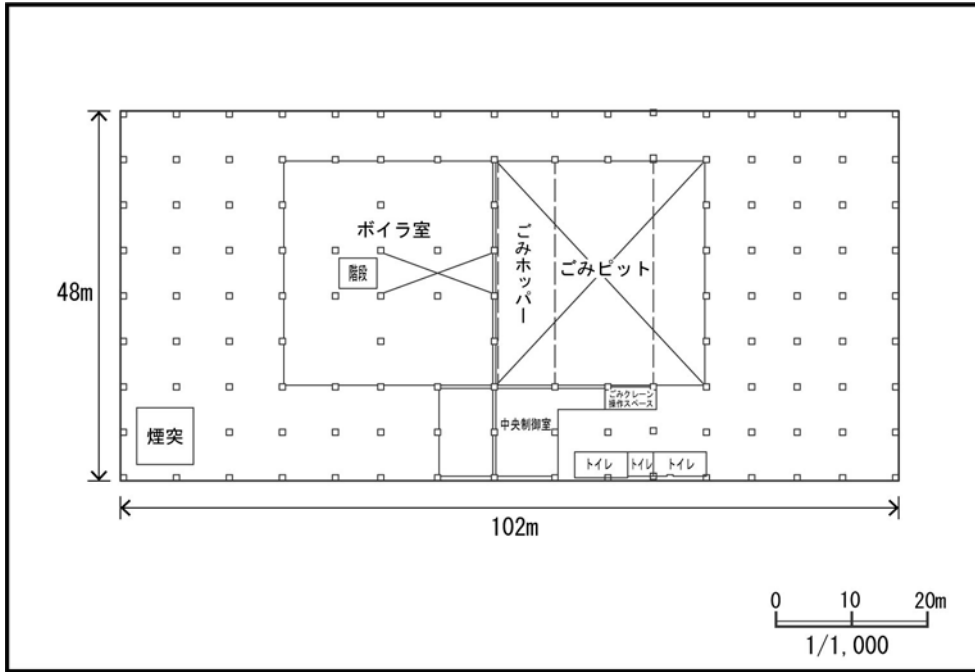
(5) 新施設の平面図（新焼却処理施設 4 階）
